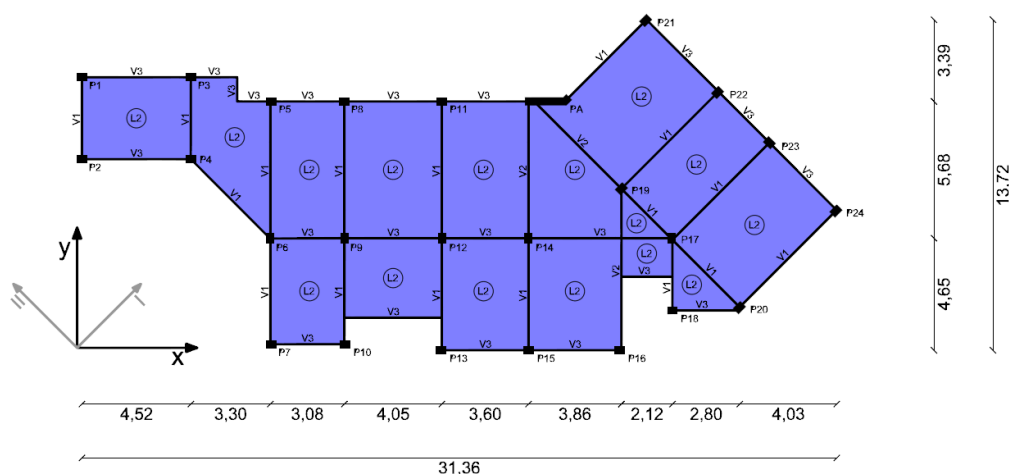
Corpo VII, primeiro piso, dimensões em metros
